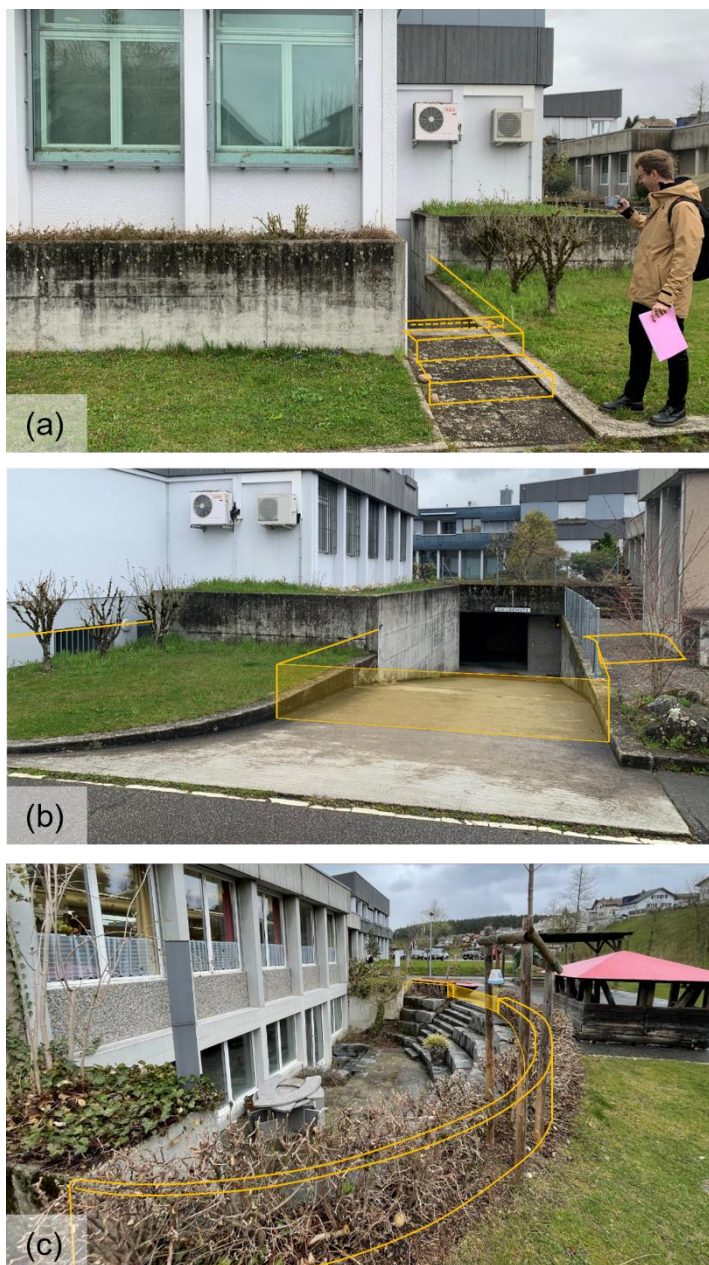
Mögliche Massnahmen Gemeindegebäudekomplex: (a) Schutzelement Kellertreppe Bankgebäude, (b) Schutzelemente Abfahrt Tiefgarage und Eingang Kindergarten und (c) Schutzelement Amphitheater Kindergarten
